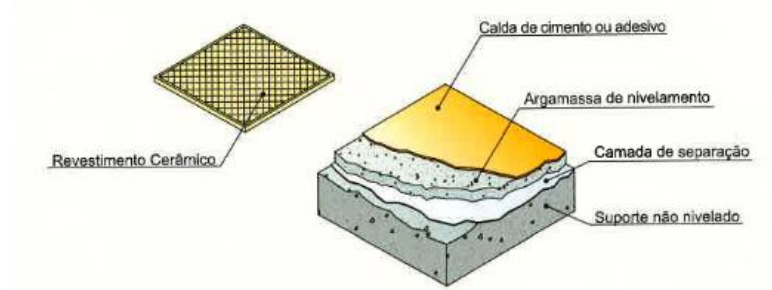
Aplicação de argamassa sobre a camada de separação [3]
